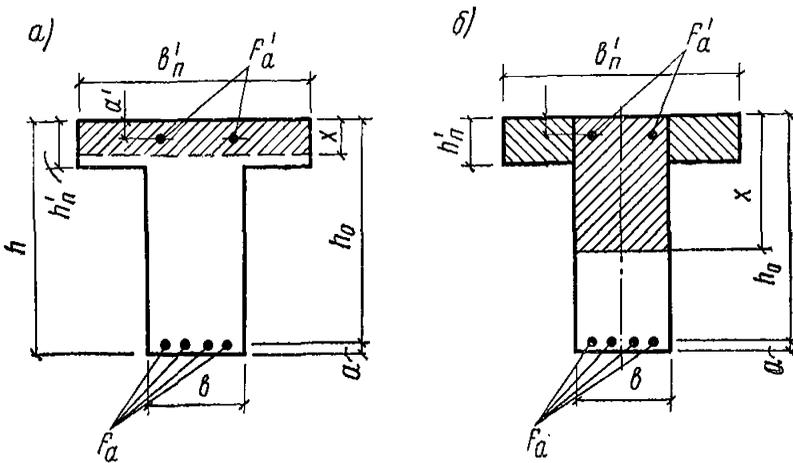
Форма сжатой зоны в сечении изгибаемого железобетонного элемента с полкой в сжатой зоне
